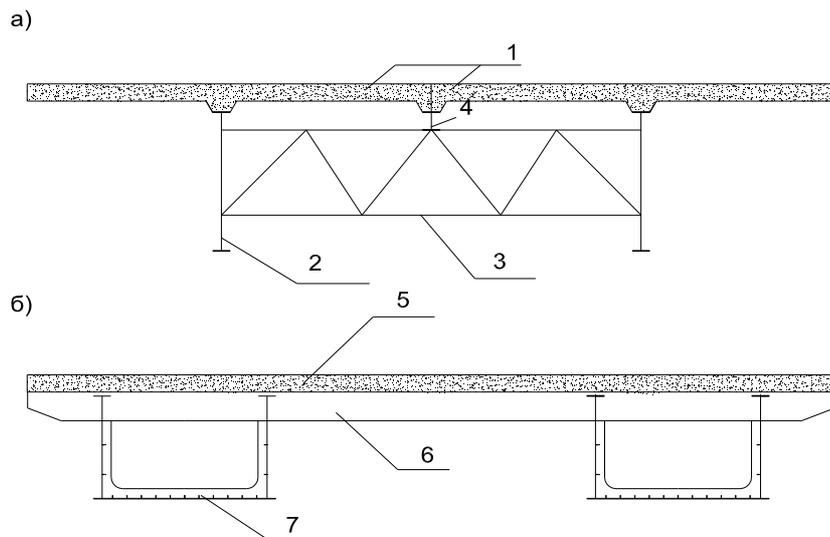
Поперечные сечения сталежелезобетонных пролетных строений: а-со сборной плитой; б-с монолитной плитой; 1-блоки железобетонной плиты; 2-главные стальные балки; 3-связи между главными балками (сквозные фермы); 4-средний сварной прогон; 5-монолитная железобетонная плита; 6-поперечная балка; 7-коробчатая балка
